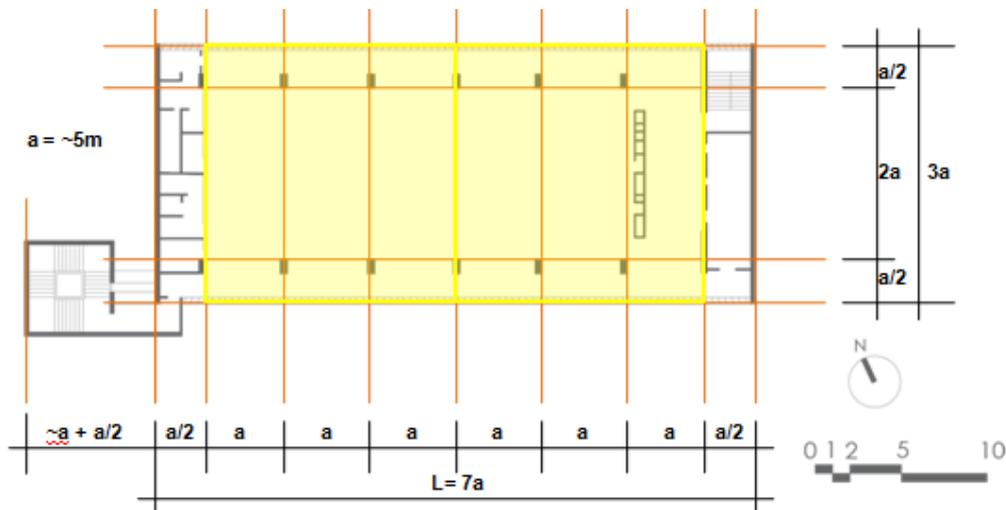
Telepar, planta esquemática andar tipo demonstrando linhas mestras; intervenção gráfica da autora.
